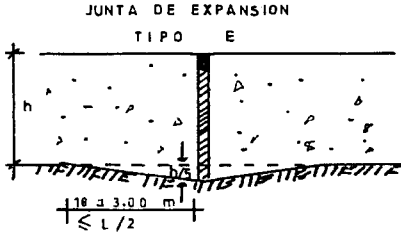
JUNTAS TÍPICAS EN PAVIMENTO RÍGIDO
